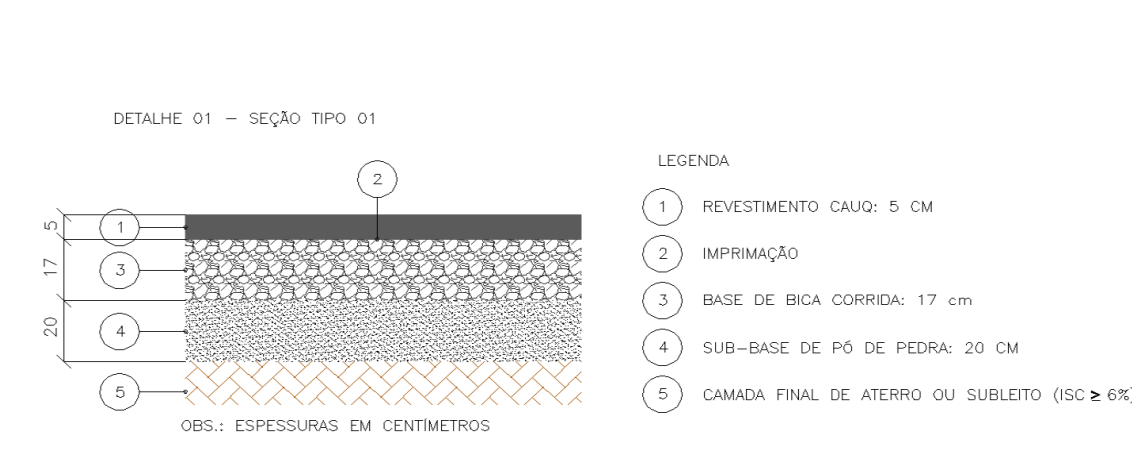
Seção tipo da estrutura do pavimento flexível. Medidas em centímetros
